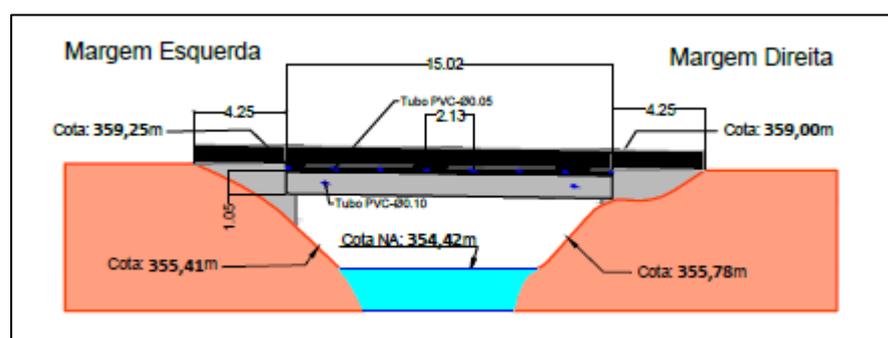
Levantamento Ponte Estrada Candido Mota 030
